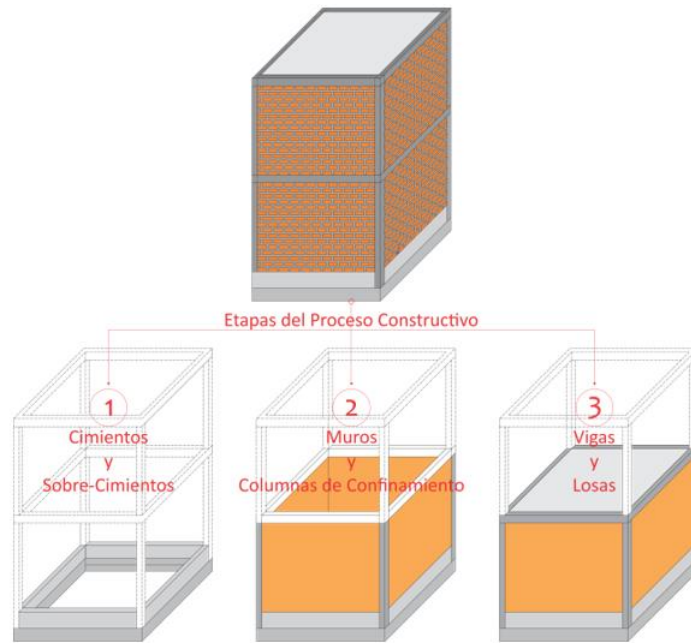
Proceso Constructivo del Sistema Estructural de Albañilería Confinada.
